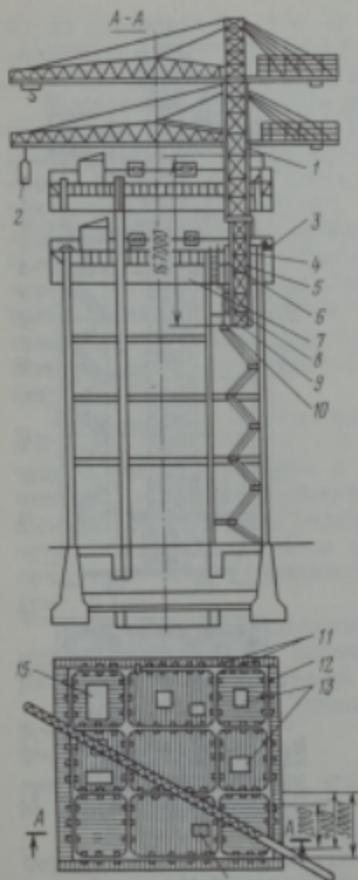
Бетонирование стен башенного копра с применением самоподъемного крана:
